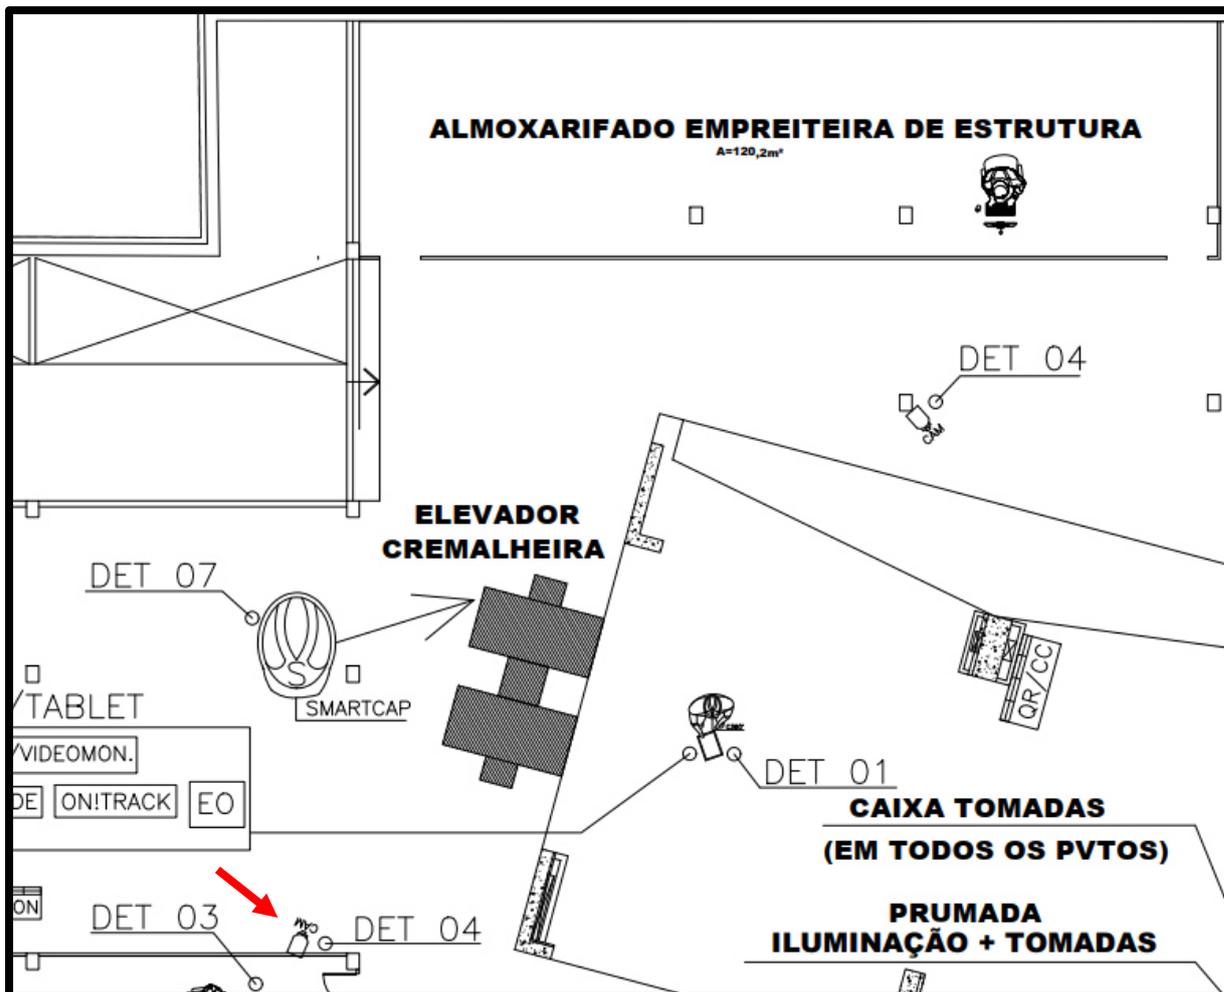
Locação da câmera para observação da área de armazenamento de cimbramento, madeiras, contramarcos, tubulações e conexões de instalações hidrossanitárias do subsolo 1 na fase 2 do canteiro
